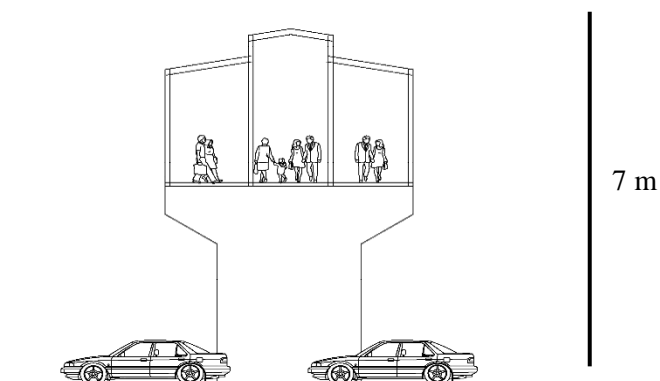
2 Potongan Ruang Pejalan Kaki Typical Zona Komersial (Kanan)
